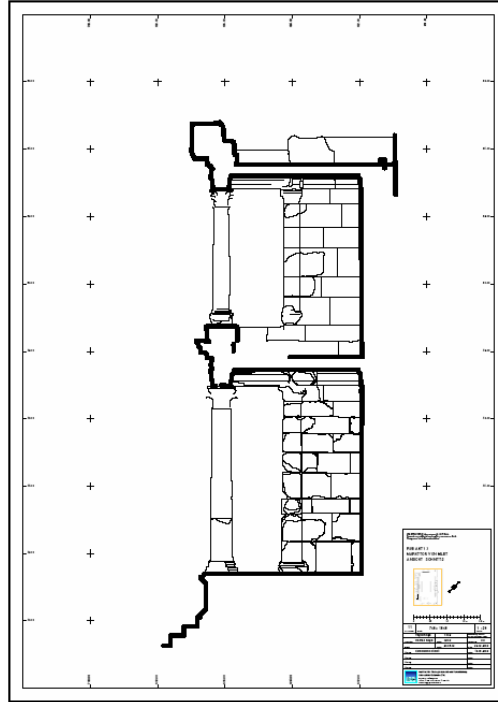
Pazar Kapısı'nın önden görünüşünün fotogrametrik planı
